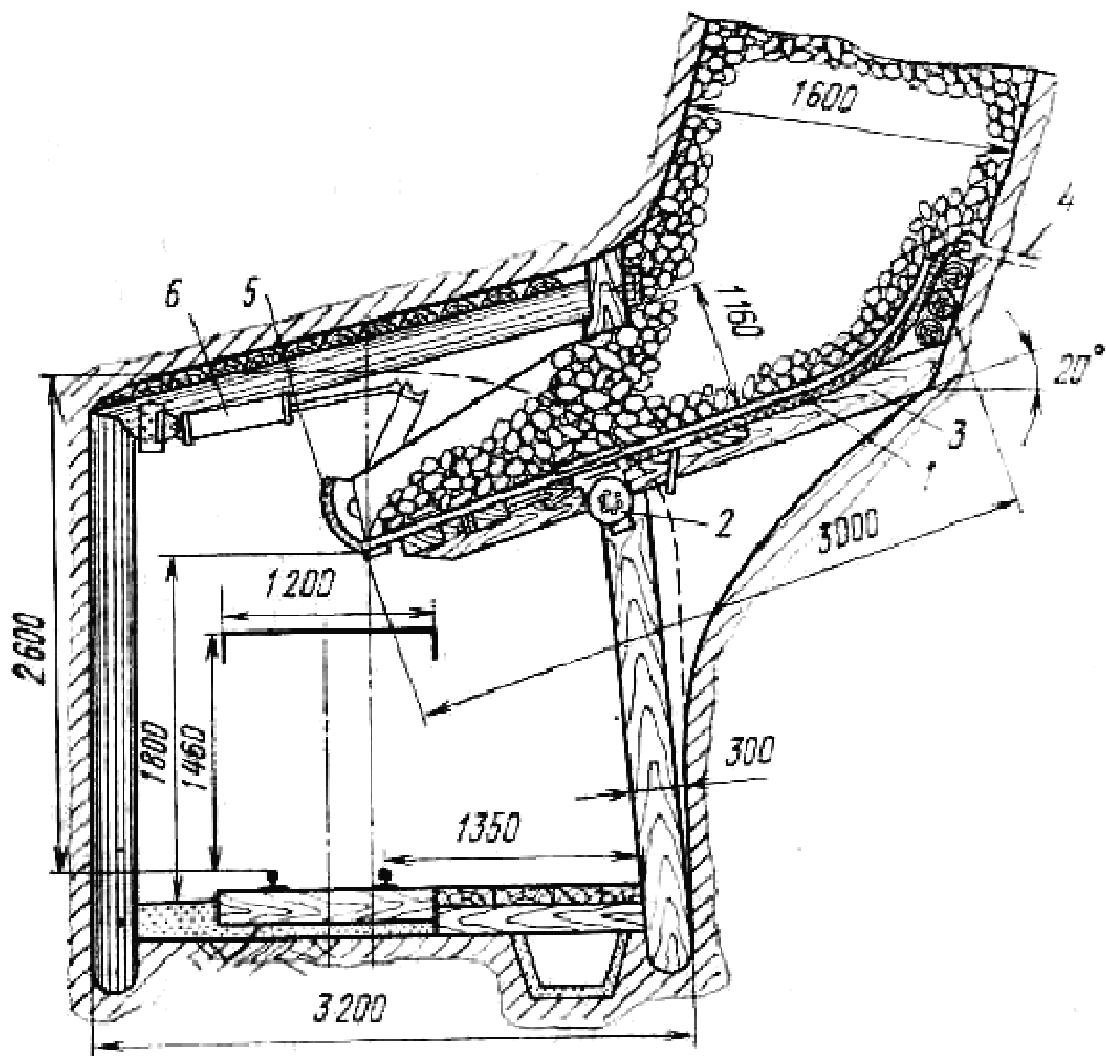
Вибролента-питатель типа ВЛР-3: 1 — вибrolента; 2 — вибратор; 3 — рама; 4 — анкерный болт; 5 — секторный затвор; 6 — пневмоцилиндр
